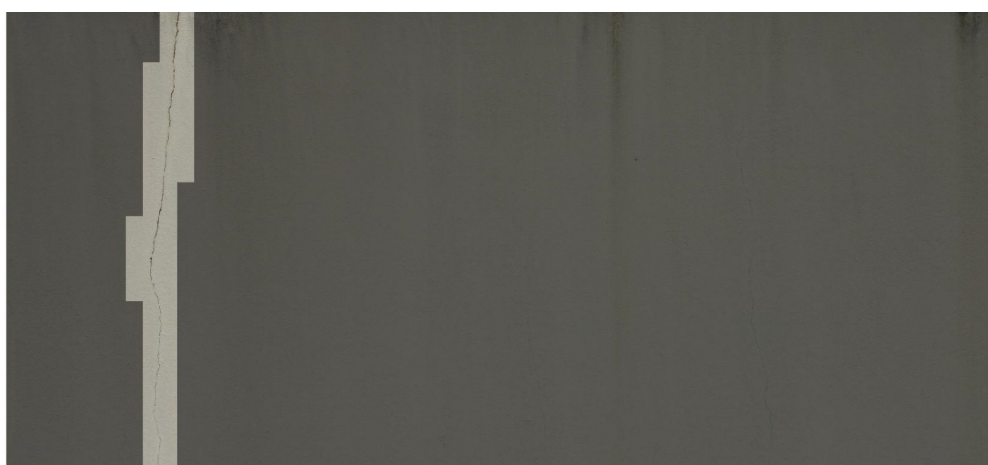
Detecção Fissura Z.F.02
